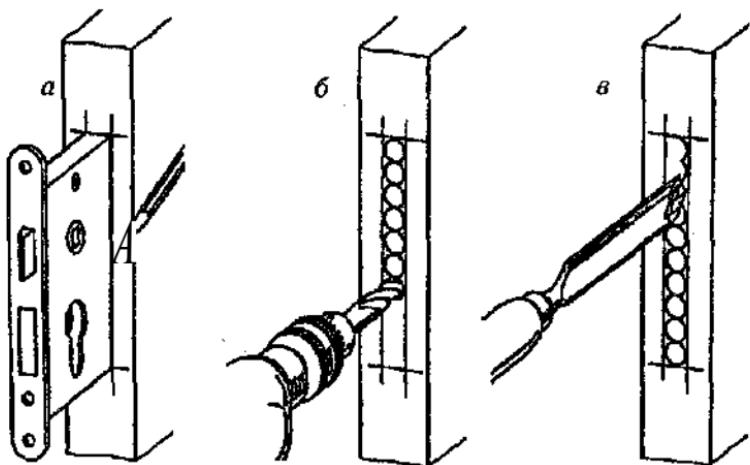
Врезка нового замка: а — нанесение разметки на торце деревянного полотна; б — сверление отверстий; в — чистка внутренней поверхности паза.
